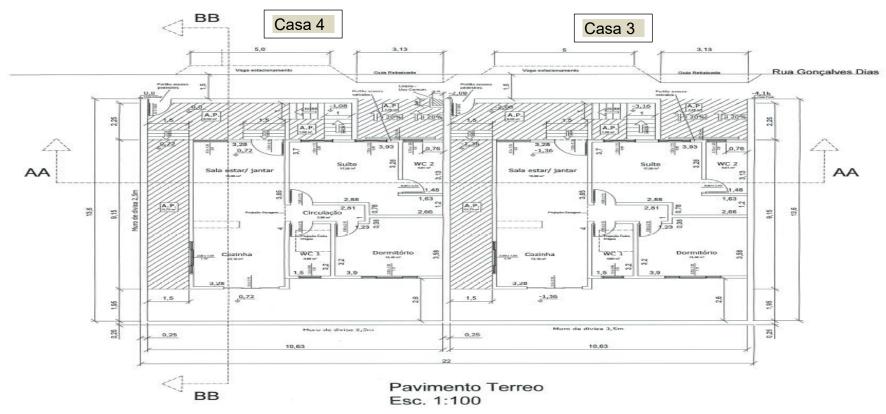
Planta Baixa Primeiro Pavimento Térreo – Estudo de Caso 2
